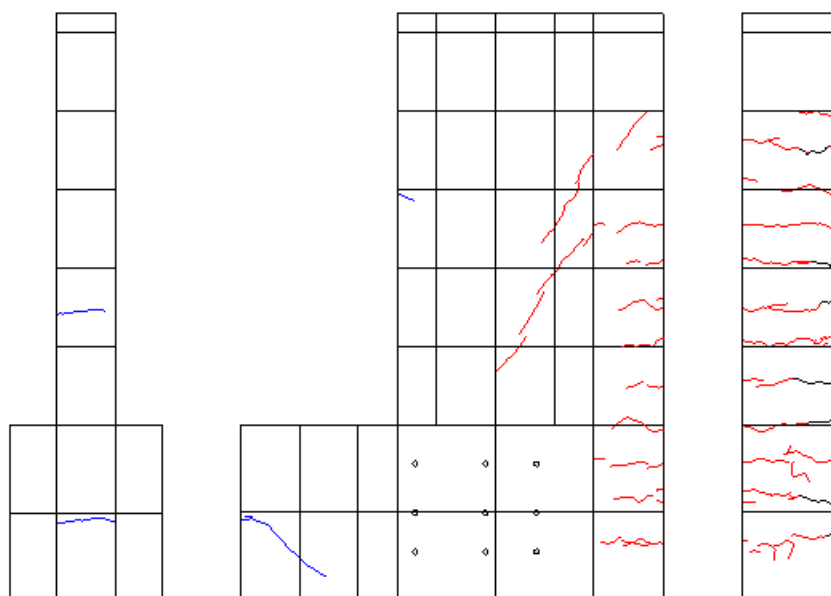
R=-1/400②ひび割れ図
